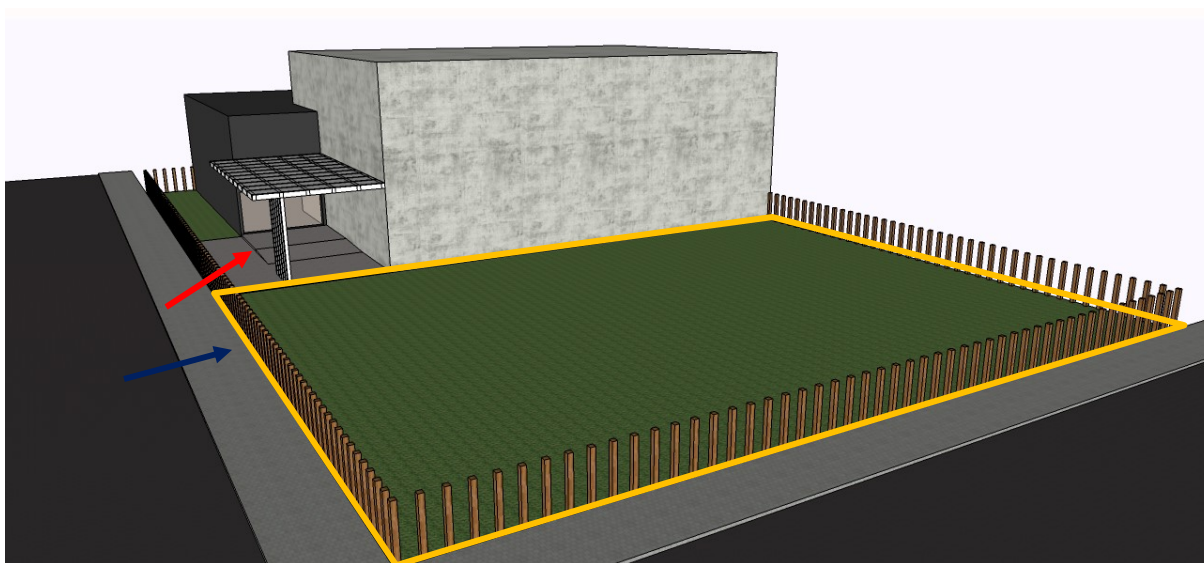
Fachada frontal vista da Lateral da ERS-239 (Fonte: Autor, 2017)
